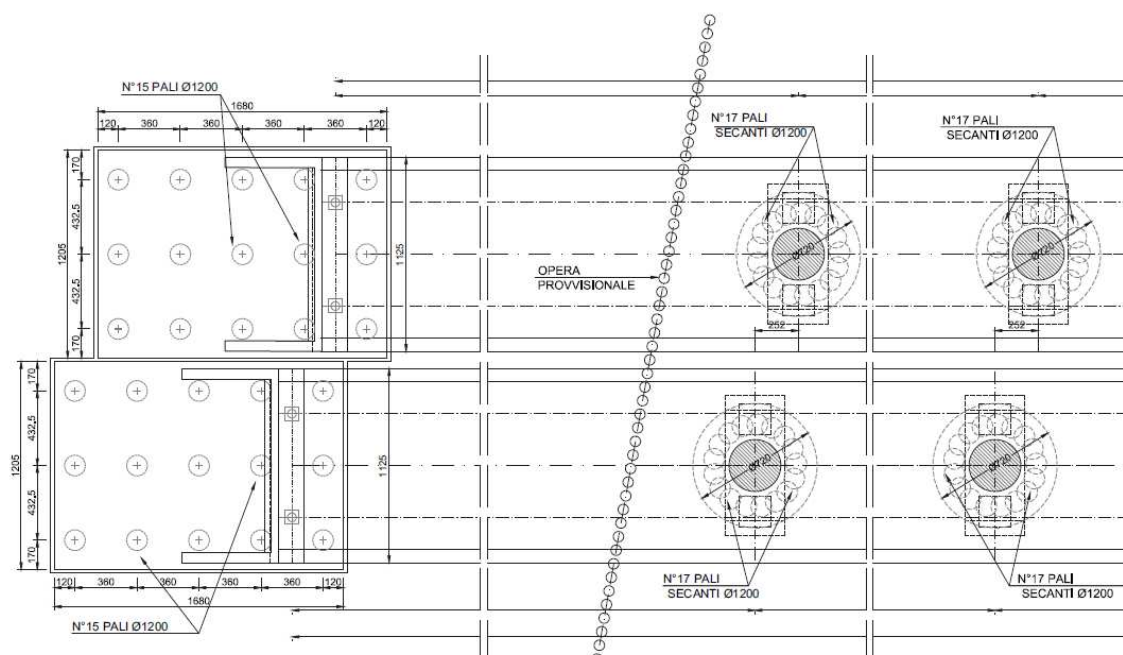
particolare pianta sottofondazioni Viadotto Sesia, Sp1-P1-P2
